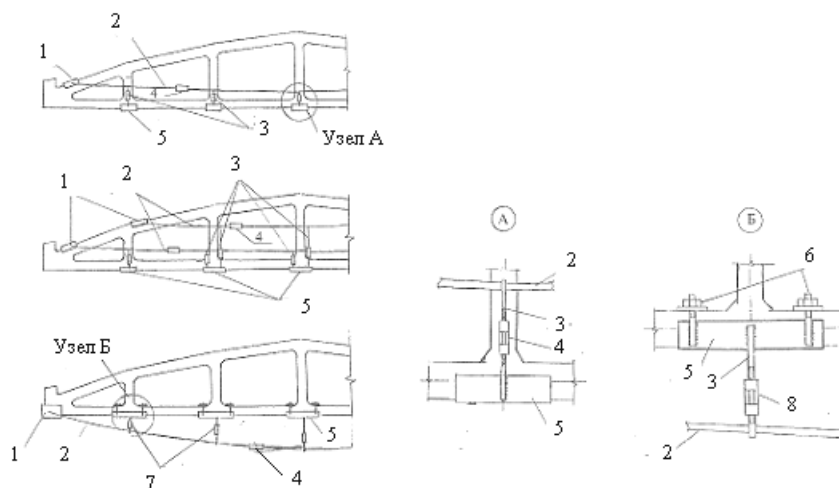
Усиление железобетонных ферм шарнирно-стержневыми цепями или тросами:
